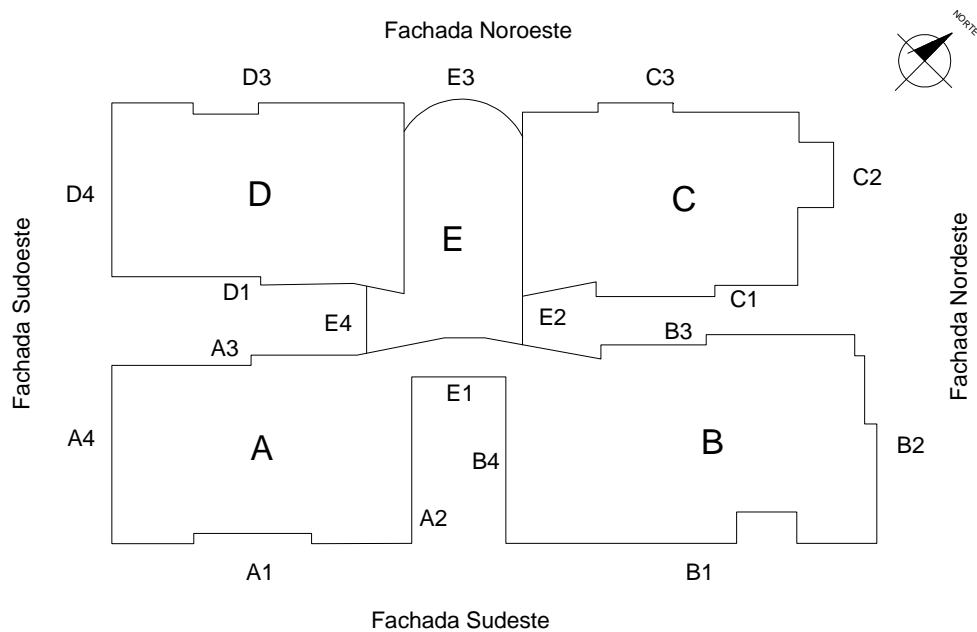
Ilustração esquemática da orientação das fachadas do edifício D.
